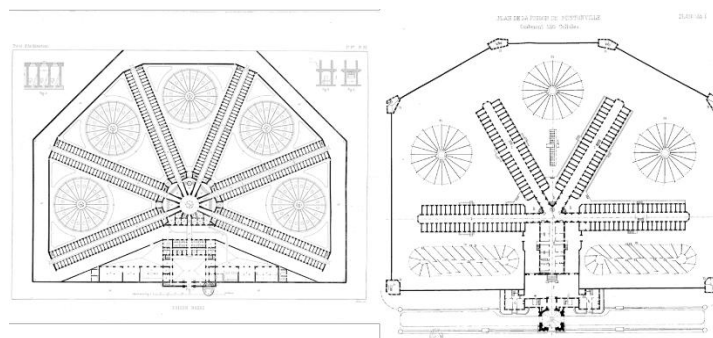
Exemples de plan à structure étoilée (Source : Criminocorpus, 2024)
